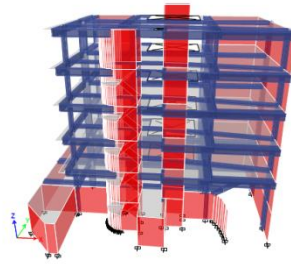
Ubicación correspondiente de las Columnas y Vigas
